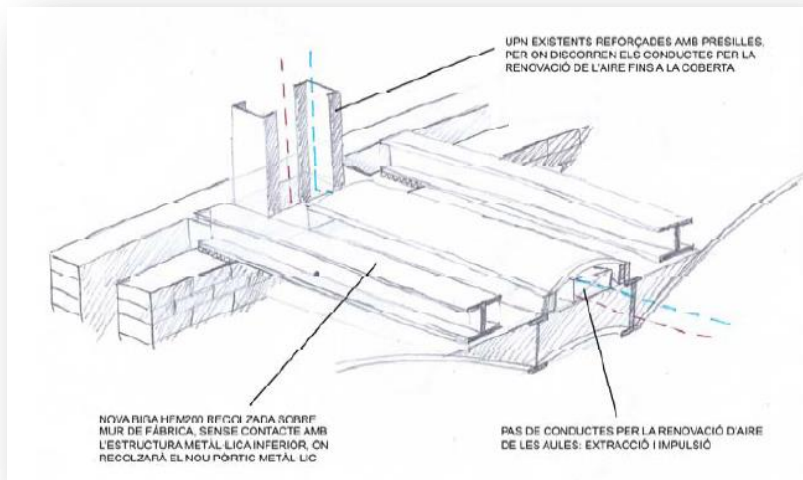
Detalle del procedimiento utilizado para transmitir la nueva carga en la estructura existente. En este caso el equipo de discentes propone realizar nuevas vigas metálicas colocadas entre la estructura horizontal existente conectadas mediante placas de anclaje a las paredes de ladrillo. Alumnos. Amalia Parra, Aleida Rojas, Oriol Altés y Carlos Godoy.
